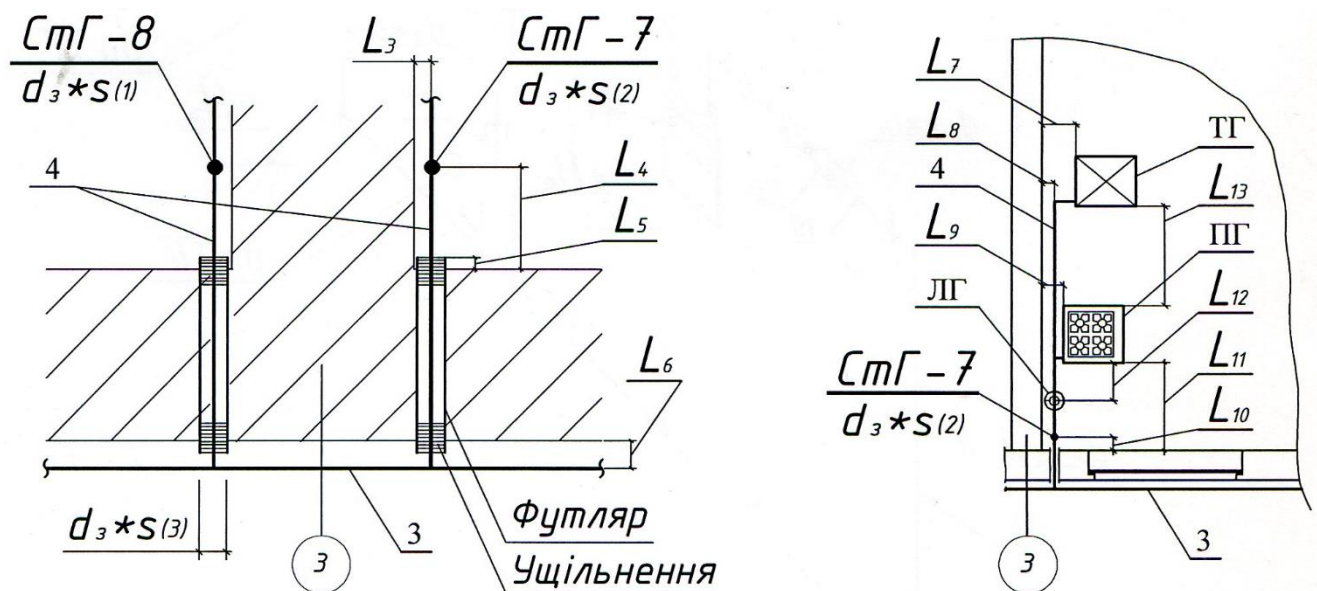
Монтажний план прокладання внутрішніх газопроводів:
